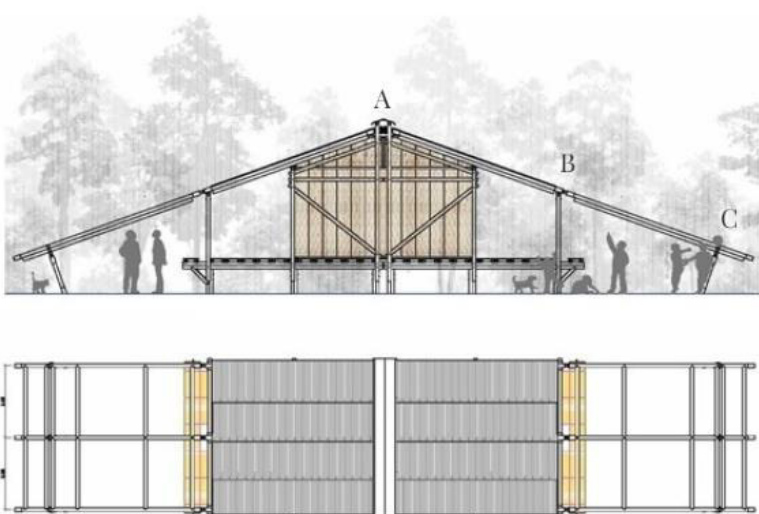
Elevación y Planta Arquitectónica de Planimetría
